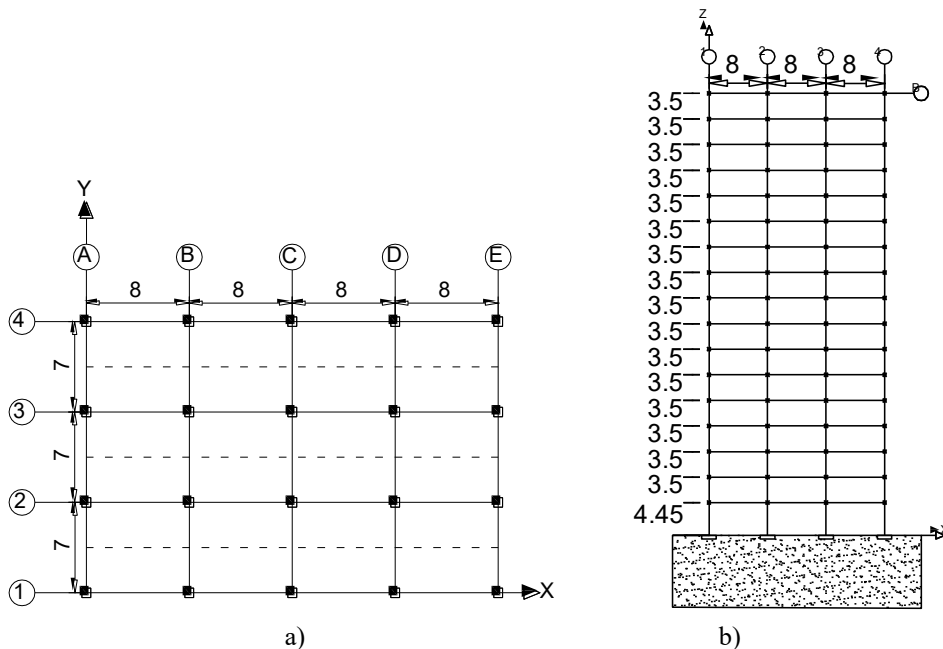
Planta tipo para la estructura de 17 niveles. Cotas en metros.
